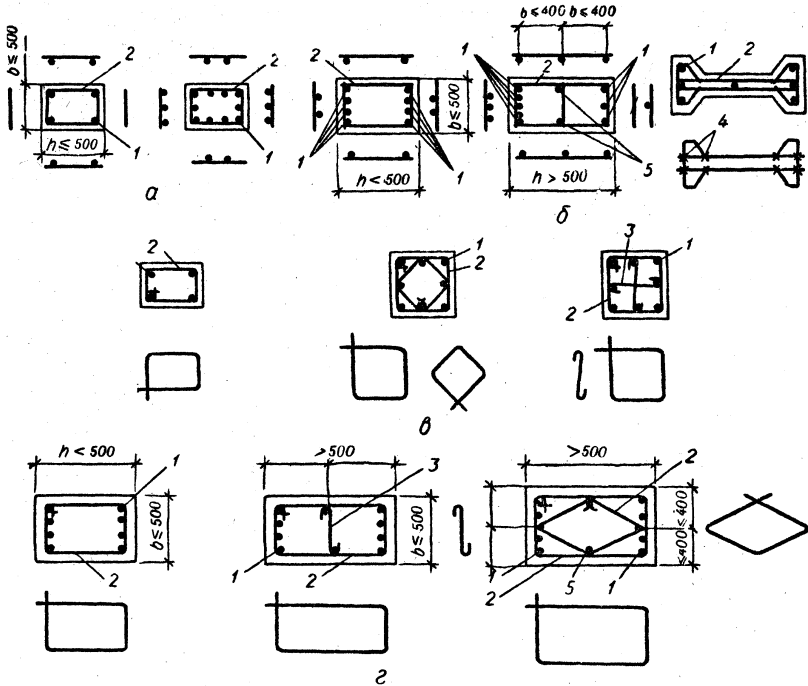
Армування стиснутих елементів: *а* – зварними каркасами при осьовому навантаженні; *б* – те саме, при позакентровому; *в* – в'язаними каркасами при осьовому навантаженні; *г* – те саме, при позакентровому; 1 – поздовжні стержні; 2 – поперечні стержні (хомути); 3 – шпильки; 4 – зварювання; 5 – конструктивні стержні діаметром на менш як 12 мм
